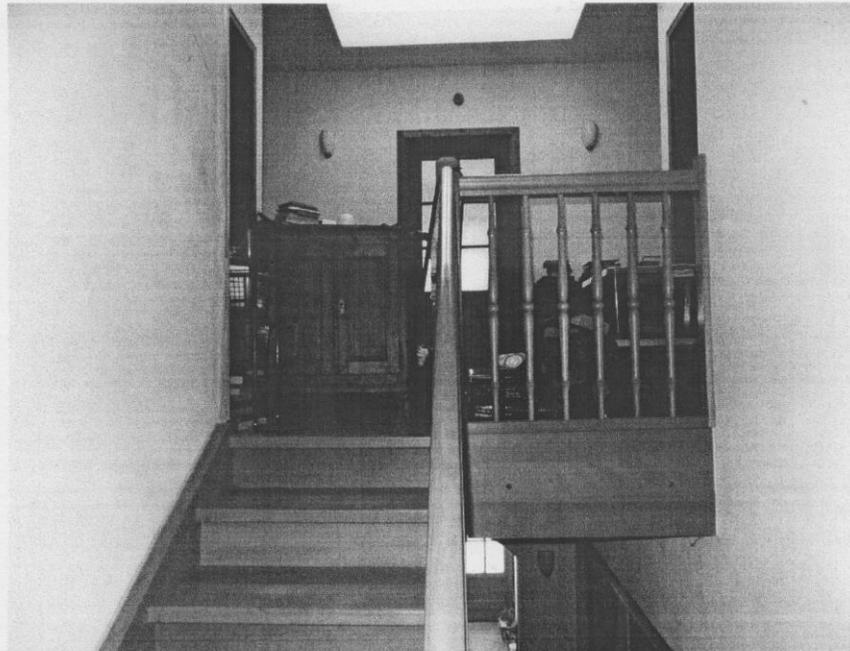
Innentreppe, Geschossdecke Obergeschoss
